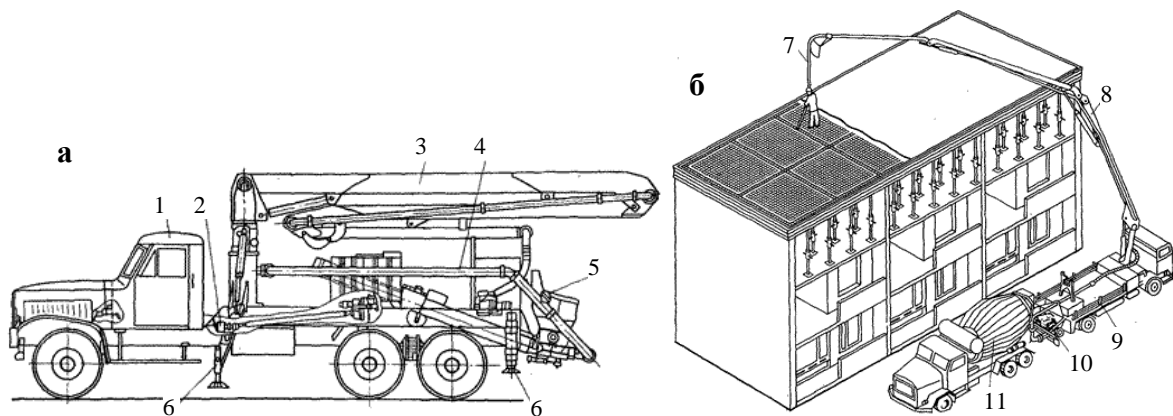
Бетонування перекриття за допомогою автобетононасоса з розподільною стрілою: а - автомобіль КрАЗ-257; б – схема бетонування; 1 – кабіна; 2 – коробка відбору потужності; 3 – стріла розподільна складена; 4 – бетононасос; 5 – пристрій прийомний; 6 – опора виносна; 7 – кінцевий рукав бетоноводу; 8 – трисекційна розподільна стріла з бетоноводом; 9 – автобетононасос; 10 – приймальний бункер; 11 – автобетонозмішувач
